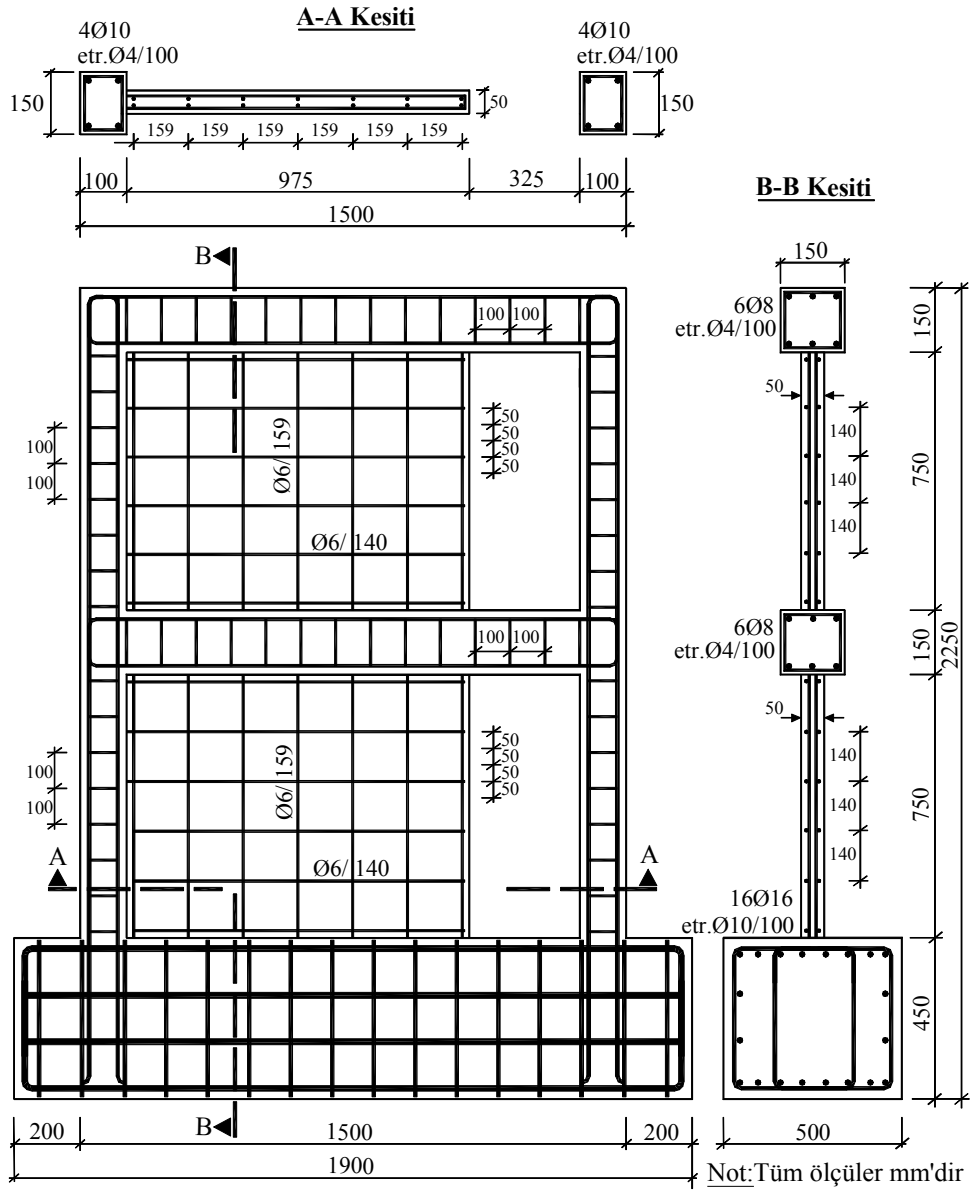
Deney Elemanı-5'in filiz donatısı detayı
